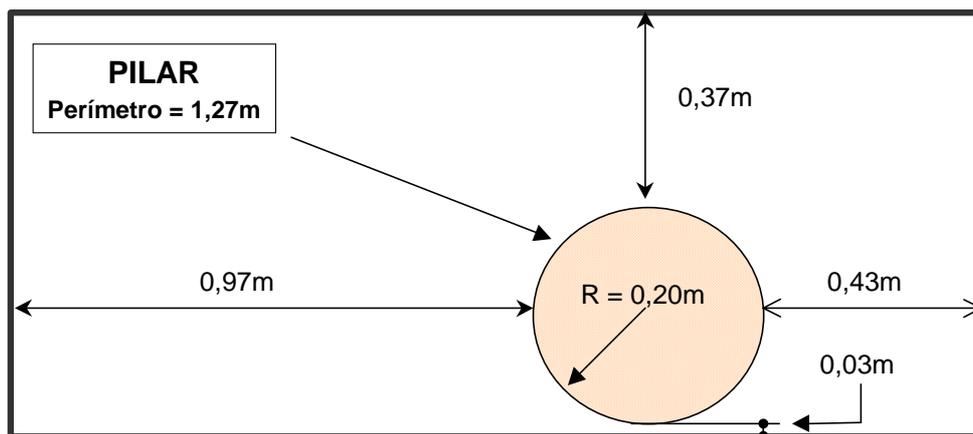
Localização do pilar sobre o bloco da escada – sem escada.
